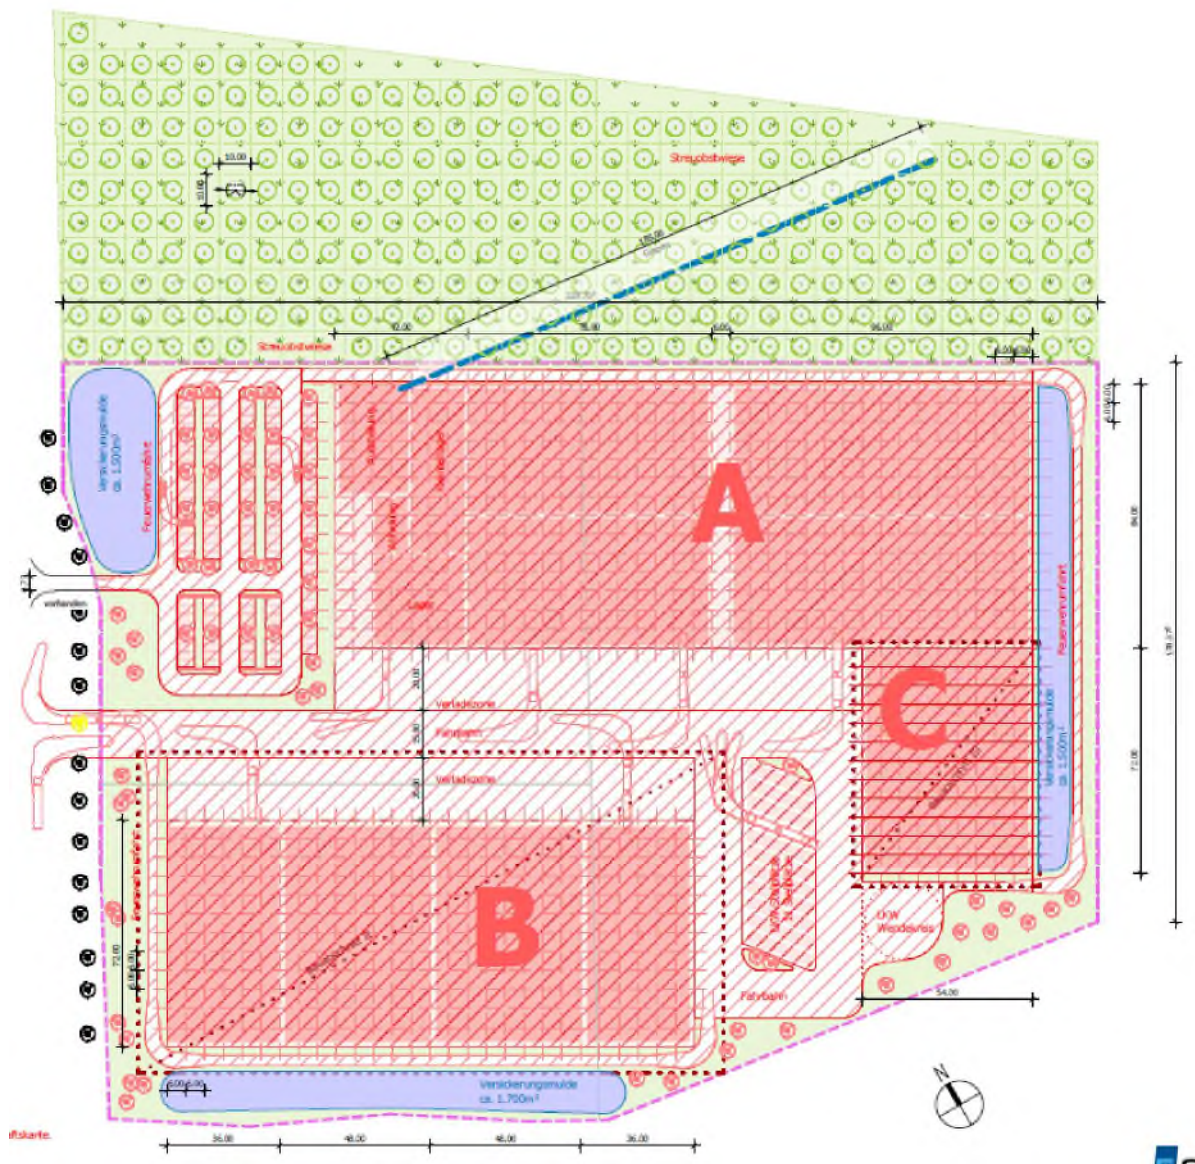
Lageplan ohne Maßstab /46/ Vorplanung innerhalb des Plangebietes
